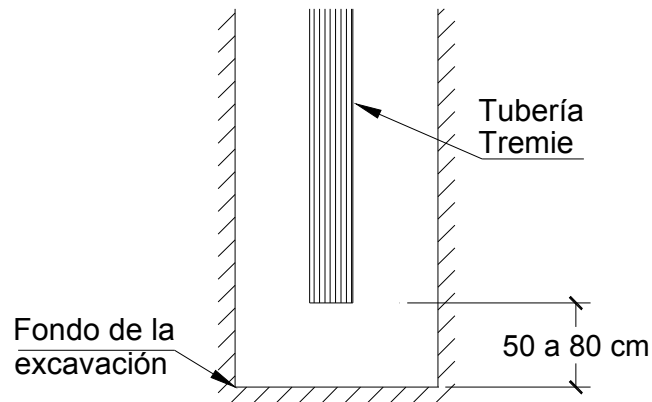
a. Separación de tubería Tremie con respecto al fondo de la excavación.
